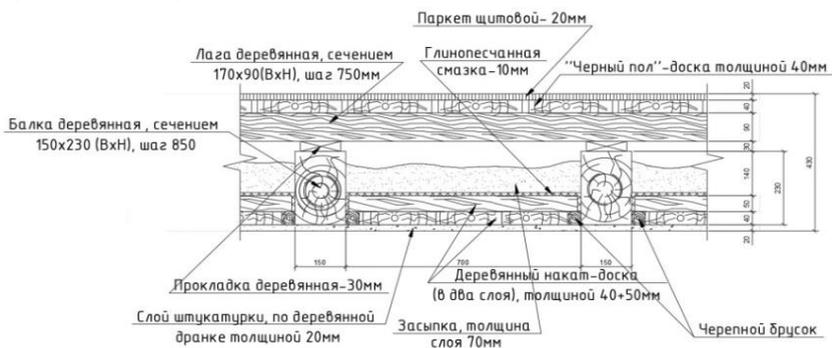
Состав междуэтажного перекрытия надземной части жилого дома 1939 г.п.
